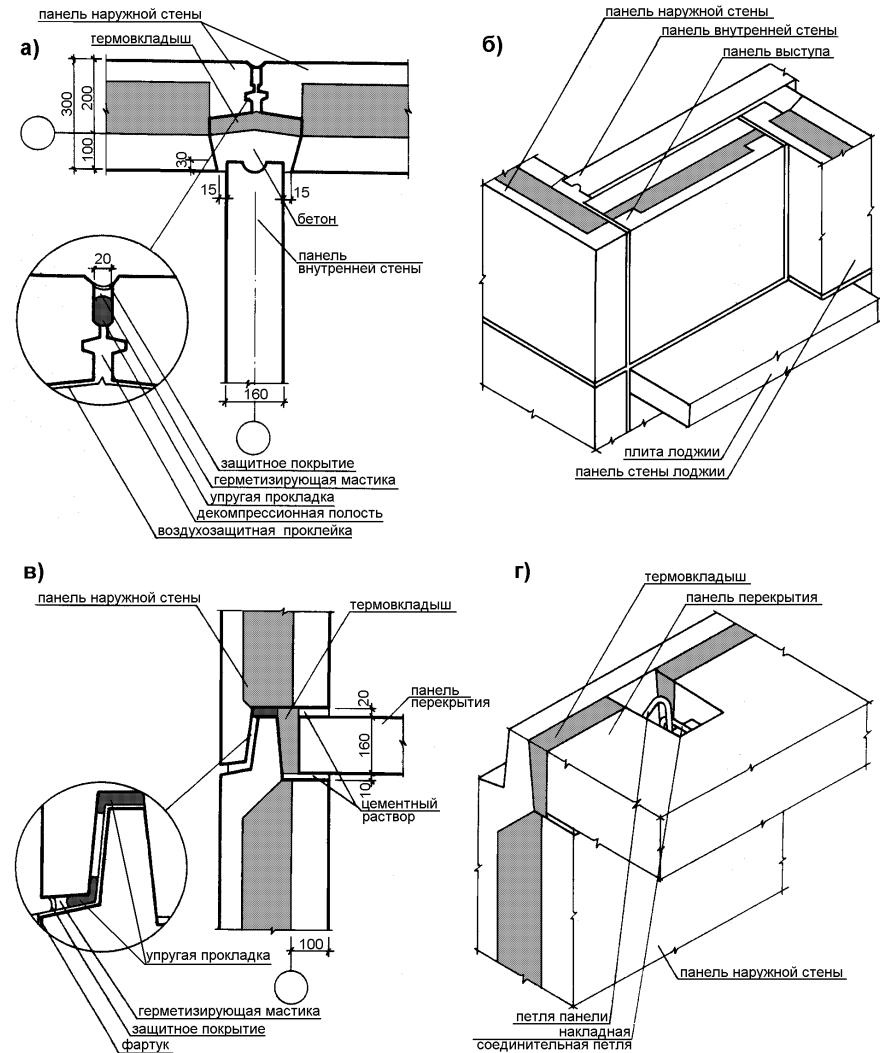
Стыки трехслойных железобетонных панелей наружных стен.
